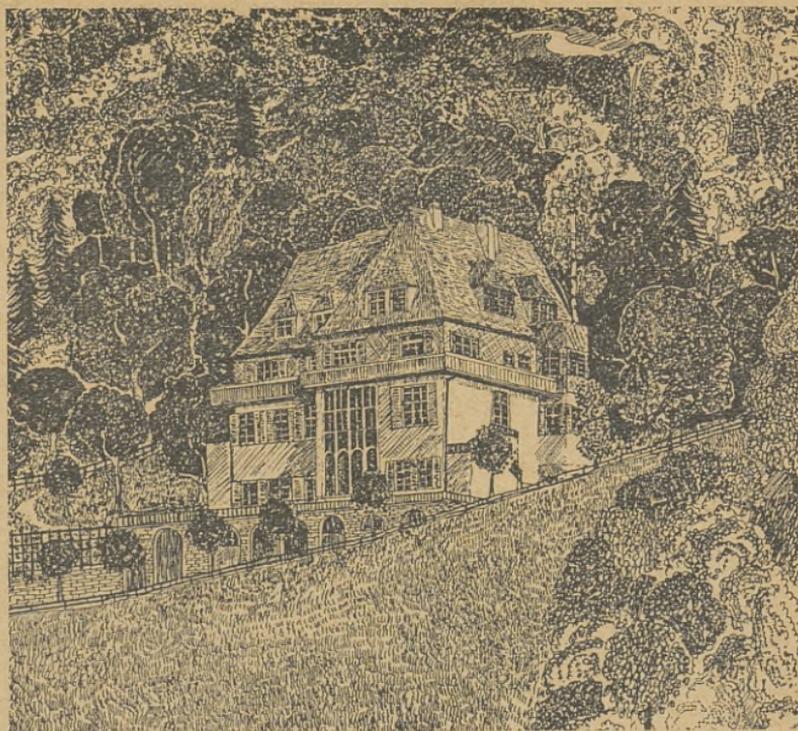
und 143. Landhaus an der Berglehne. Erdgeschoß mit Halle, Wirtschaftsräumen, Eßzimmer und Rauchzimmer
